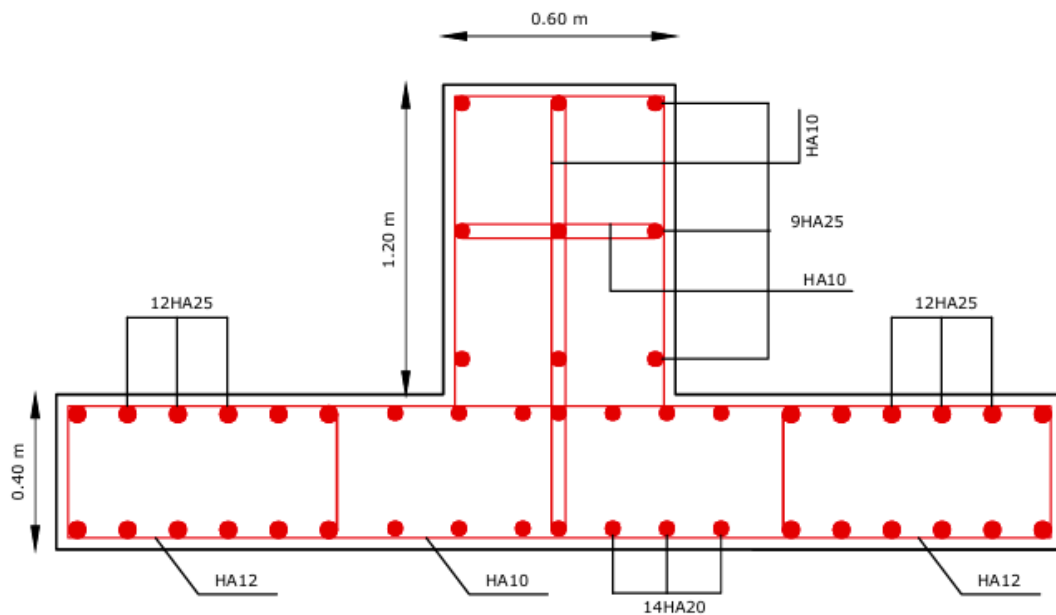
« Croquis de ferrailage du radier nervurés »
